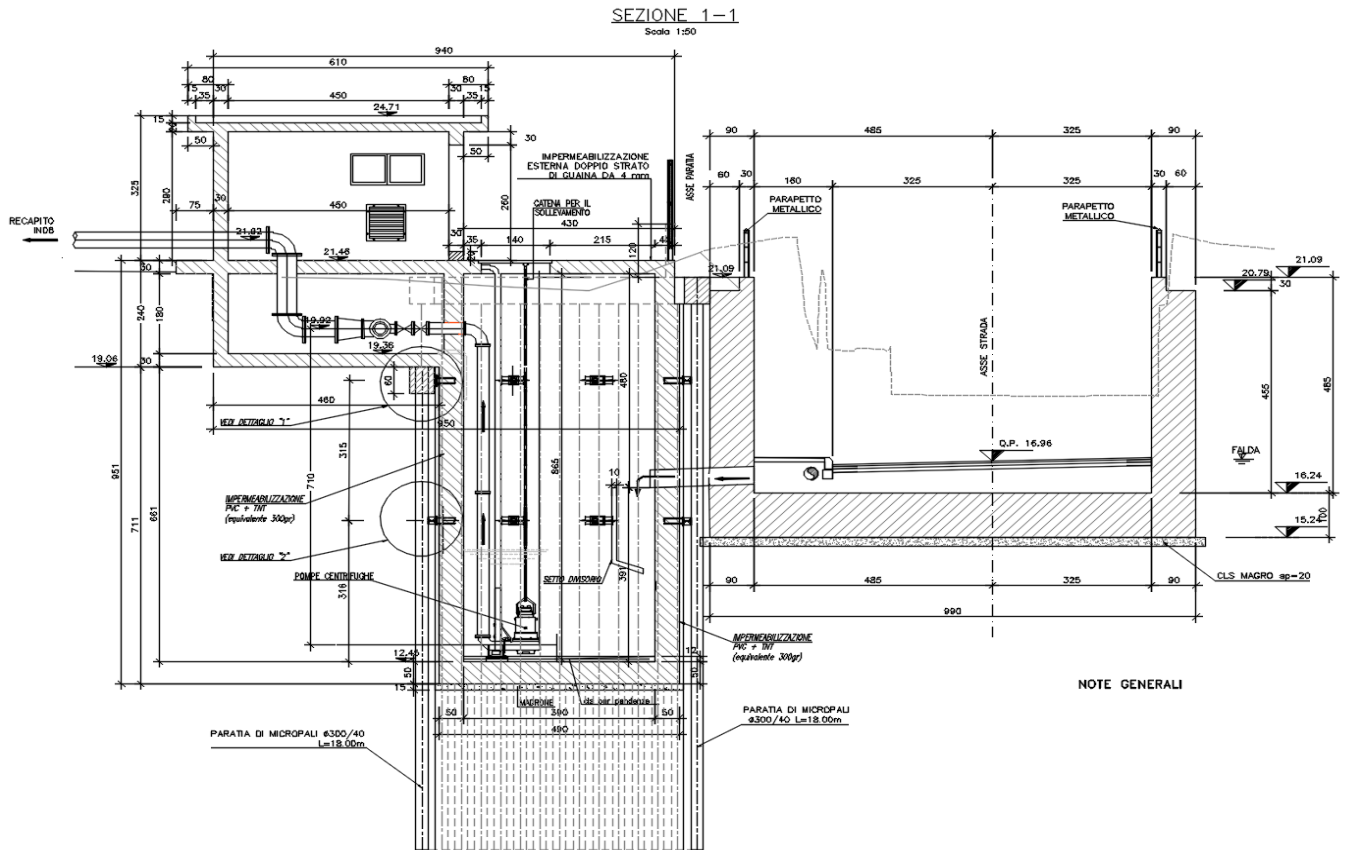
Impianto di sollevamento NV13 – Sezione
